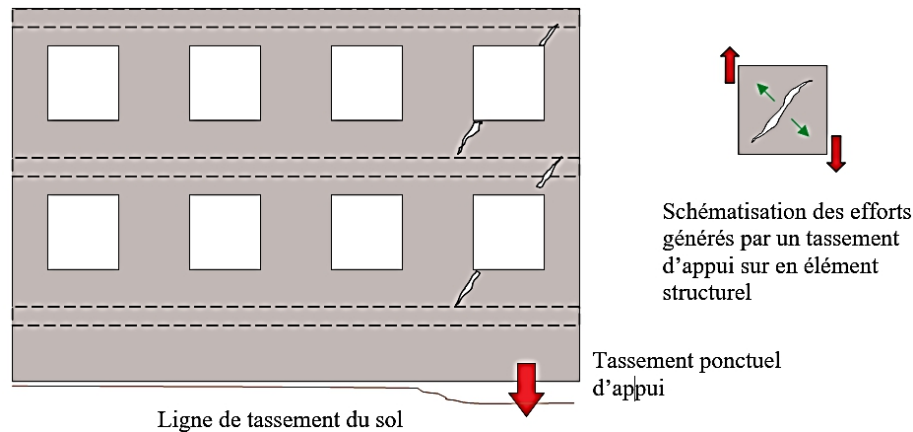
Fissuration liée au tassement d'appui
